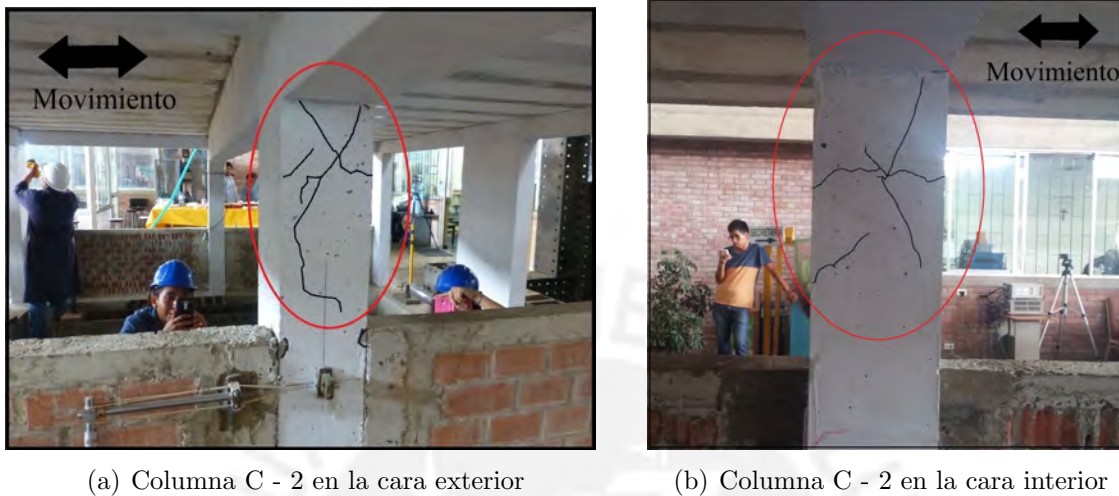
Post Fase 3, inicio de la falla tipo corte de la columna C - 2 del primer piso
